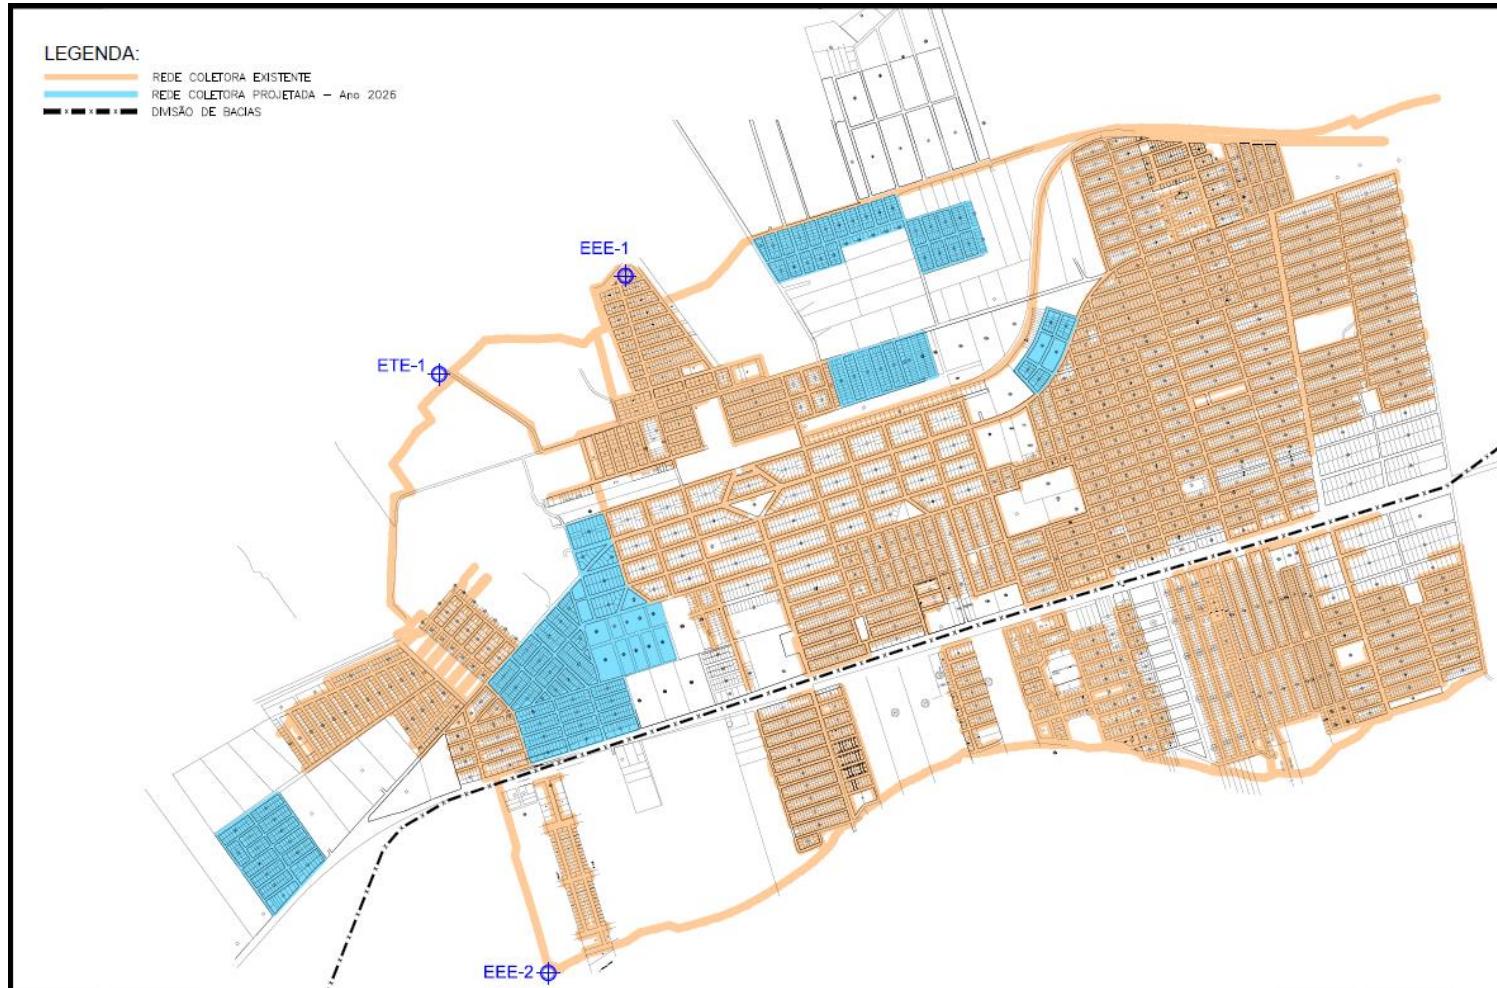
Redes Existentes (laranja) e Projetadas (azul) de esgotamento Sanitário.
